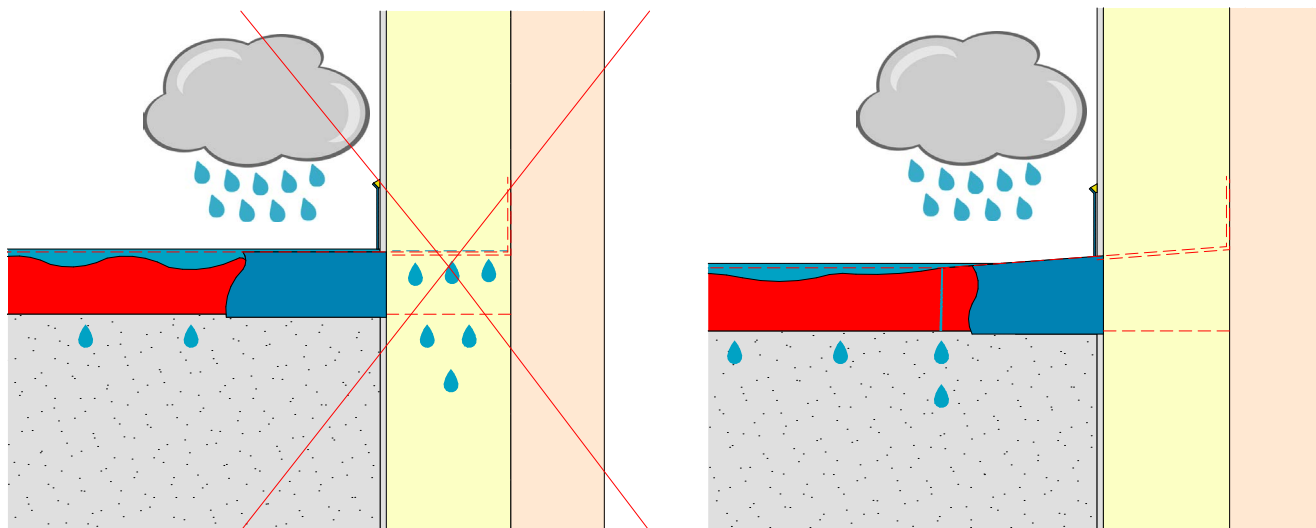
coupe de la fermeture de bord du toit avec un raccordement au mur surélevé d'au moins 25 mm
